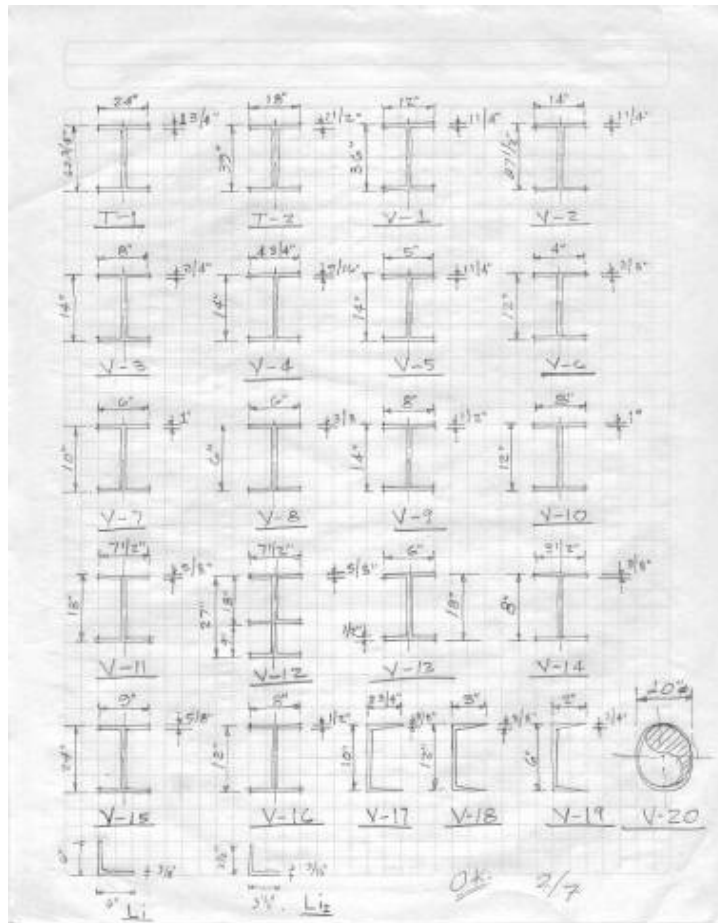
CROQUIS DE SECCIONES TRANSVERSALES DE LOS ELEMENTOS DE LOS SISTEMAS DE PISO
